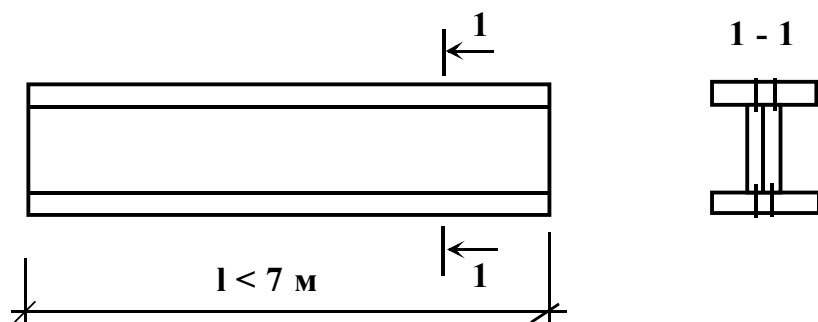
Дощатоклееная балка со стенкой из досок на ребро
